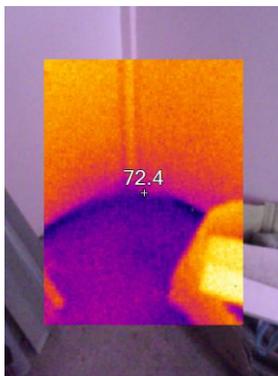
Foto térmica de la esquina de piso a muro ubicado al sur.
